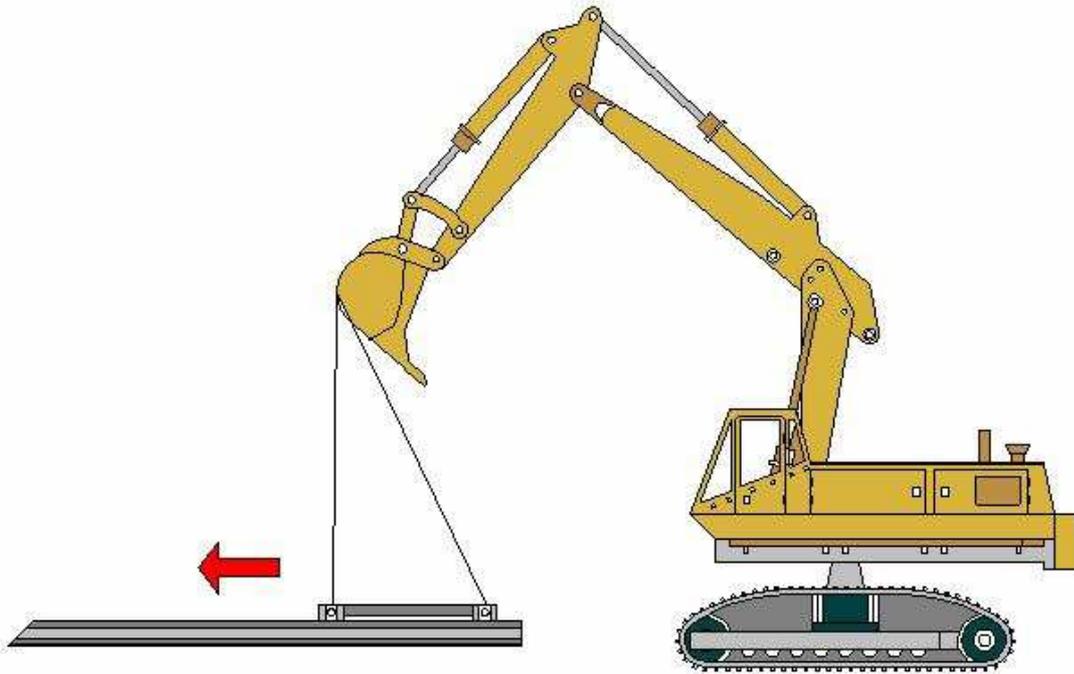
Colocación del primer Marco Guía con utilización de una excavadora./Elaboración Propia.
